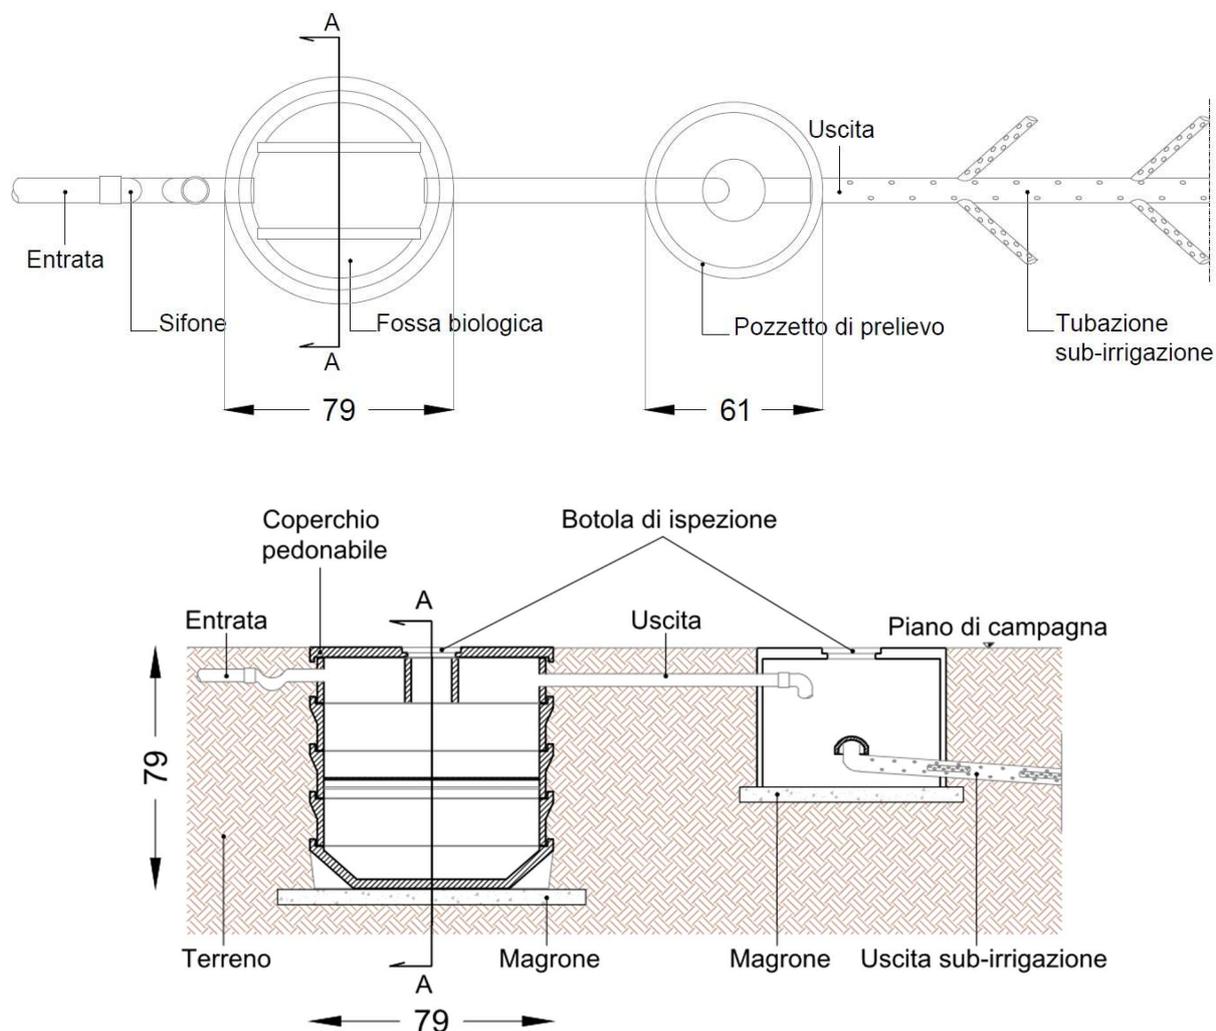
Fossa Imhoff, sezione e pianta; misure in cm
